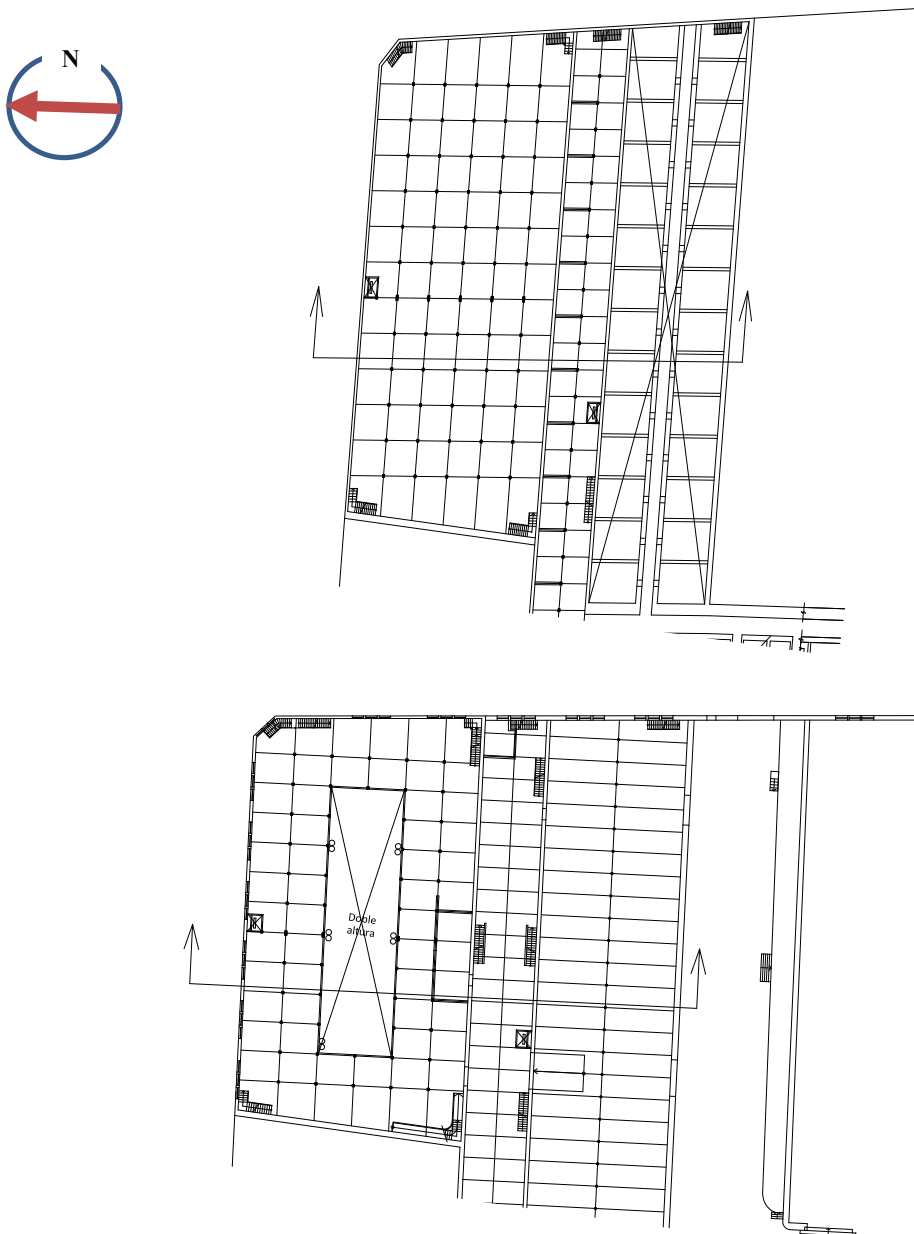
Planta del sector analizado en planta subsuelo (sup.) y planta baja (inf.).
